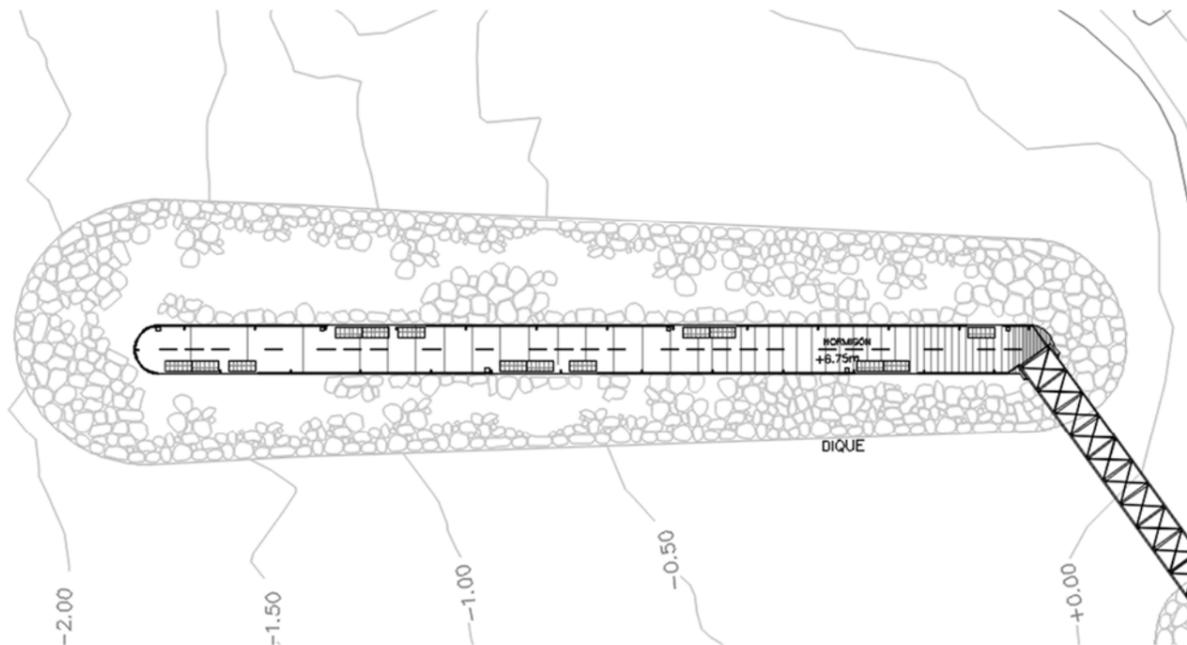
PLANTA DE ESTADO REFORMADO DEL DIQUE
